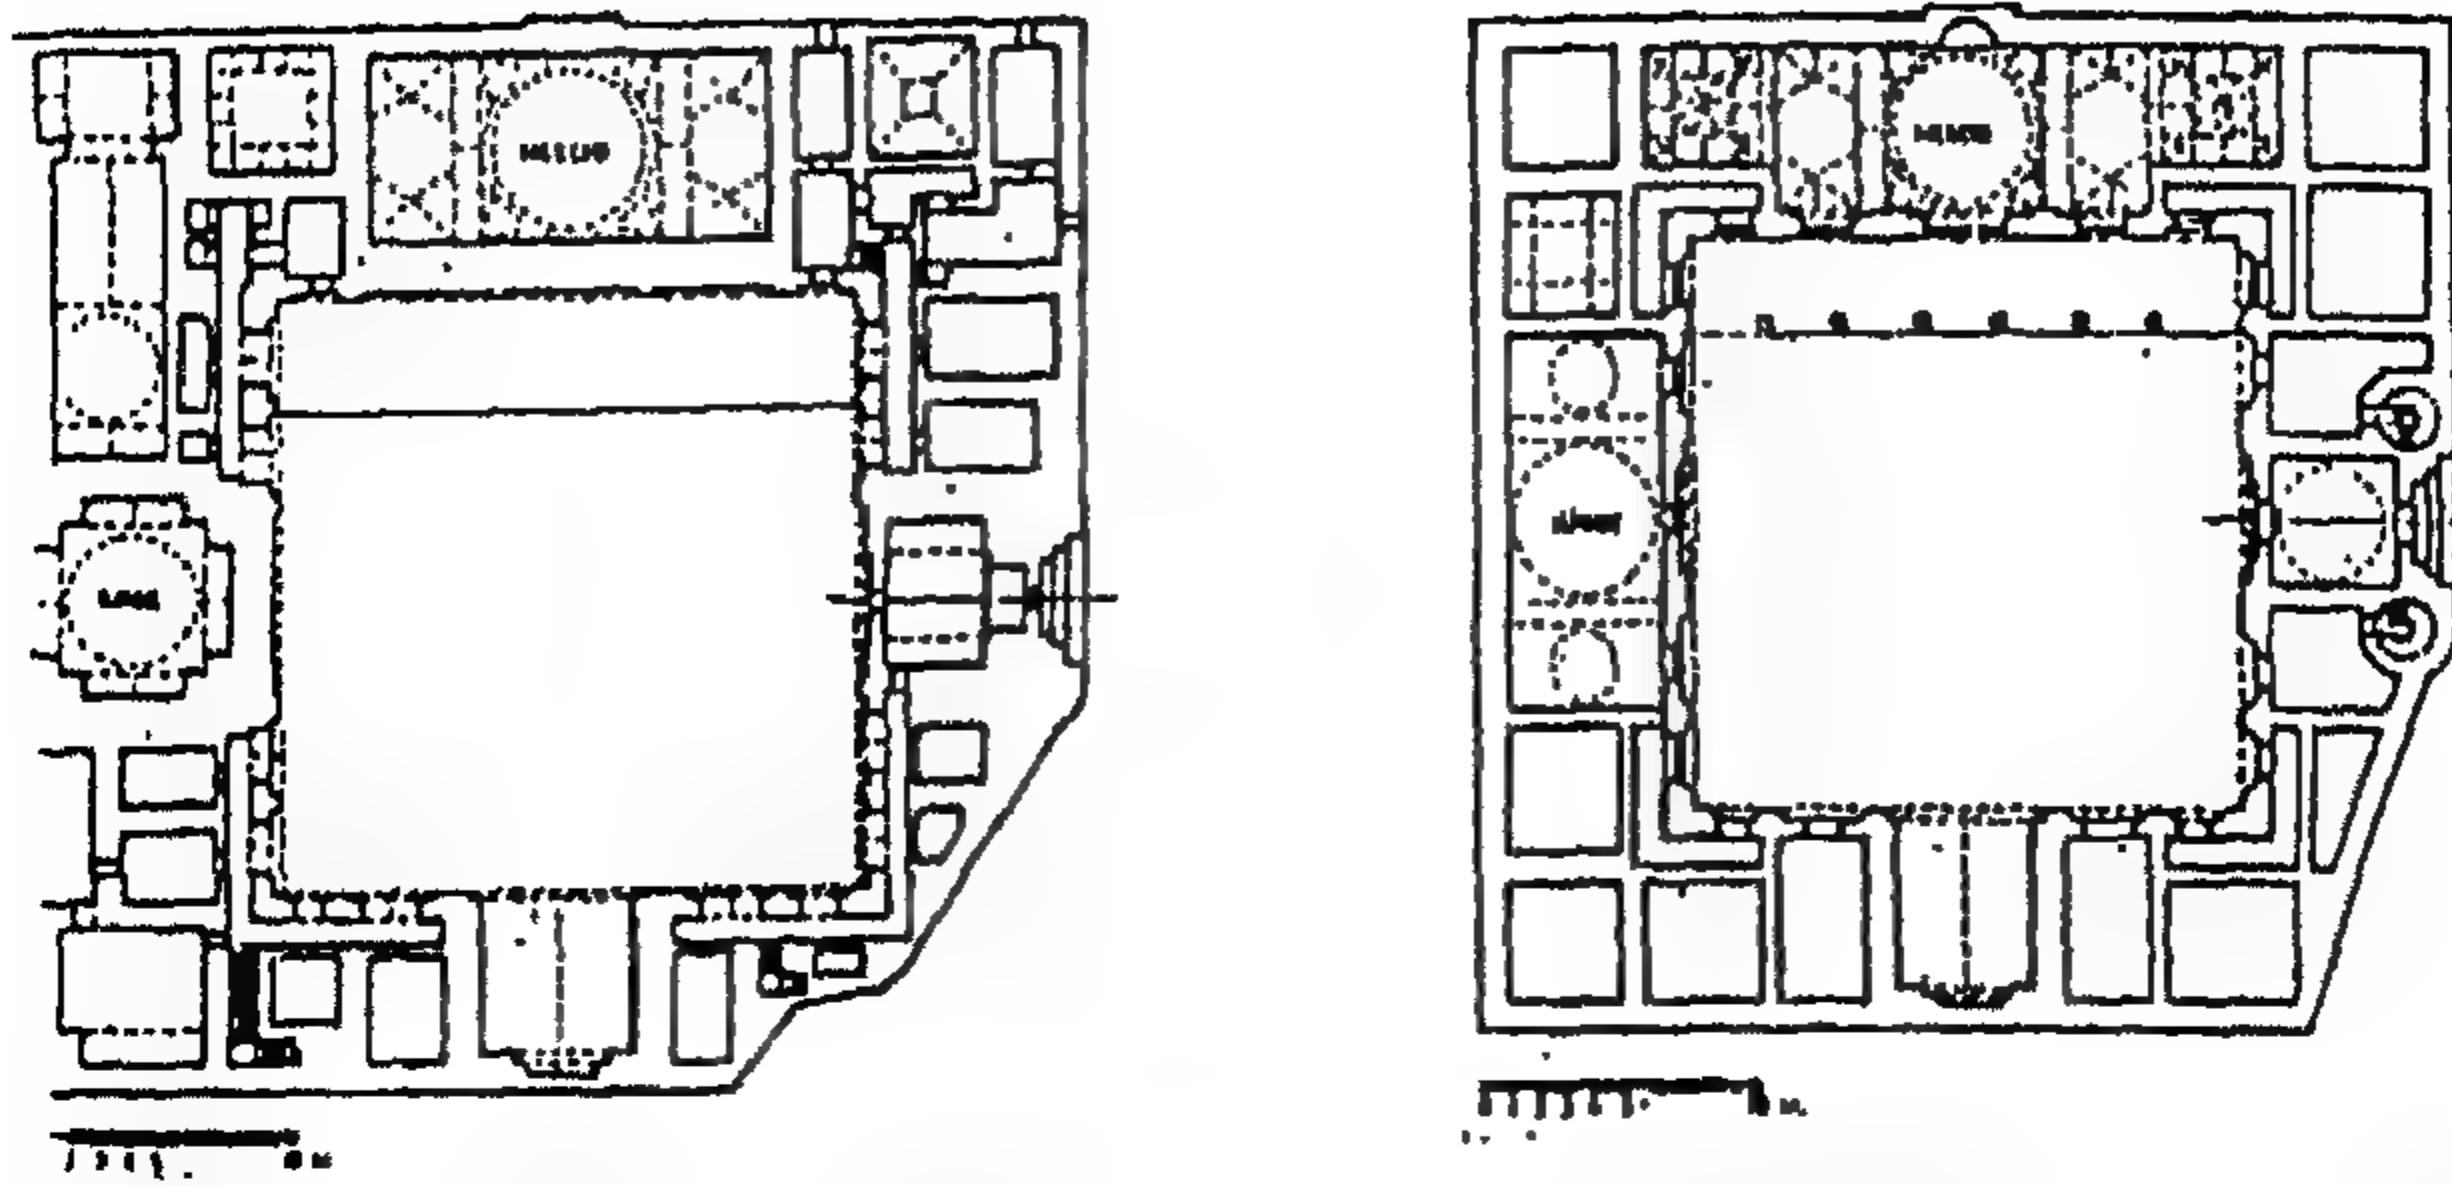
المدرسة المستنصرية ببغداد : مسقط أفقي للطابق الأرضي .
